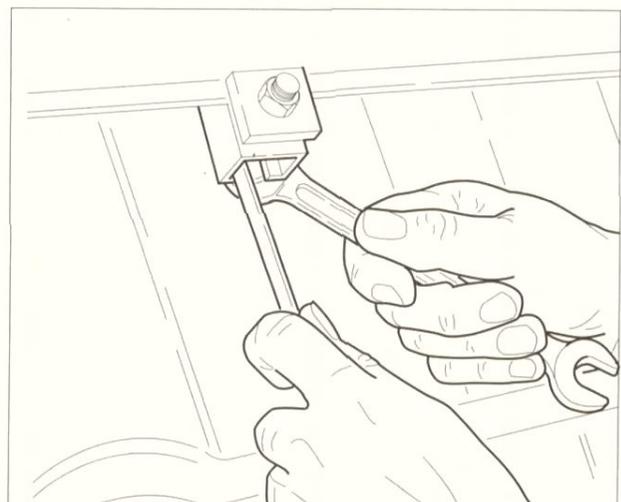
Wenn Blitzschutz am Haus vorhanden, Kollektor an Montagesschiene mit Blitzableiterklemme (Option) anschließen.
